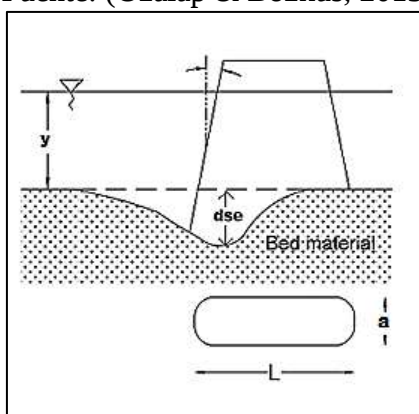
20 Vista lateral de la erosión local en pilar con estrechamiento hacia abajo.
